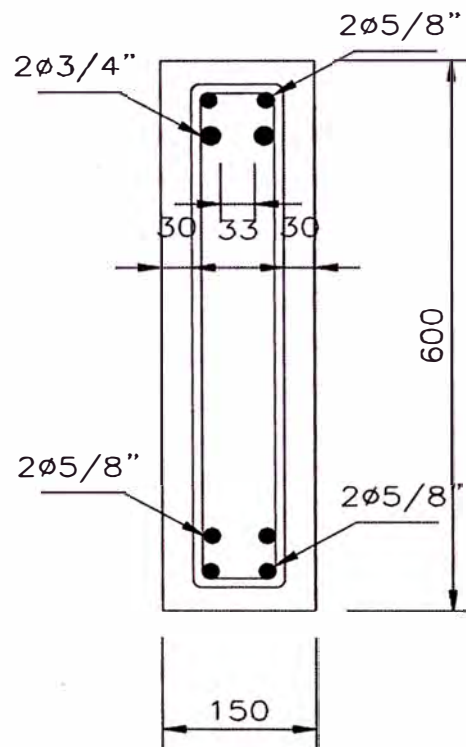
Sección transversal propuesta de la viga VT-1.
